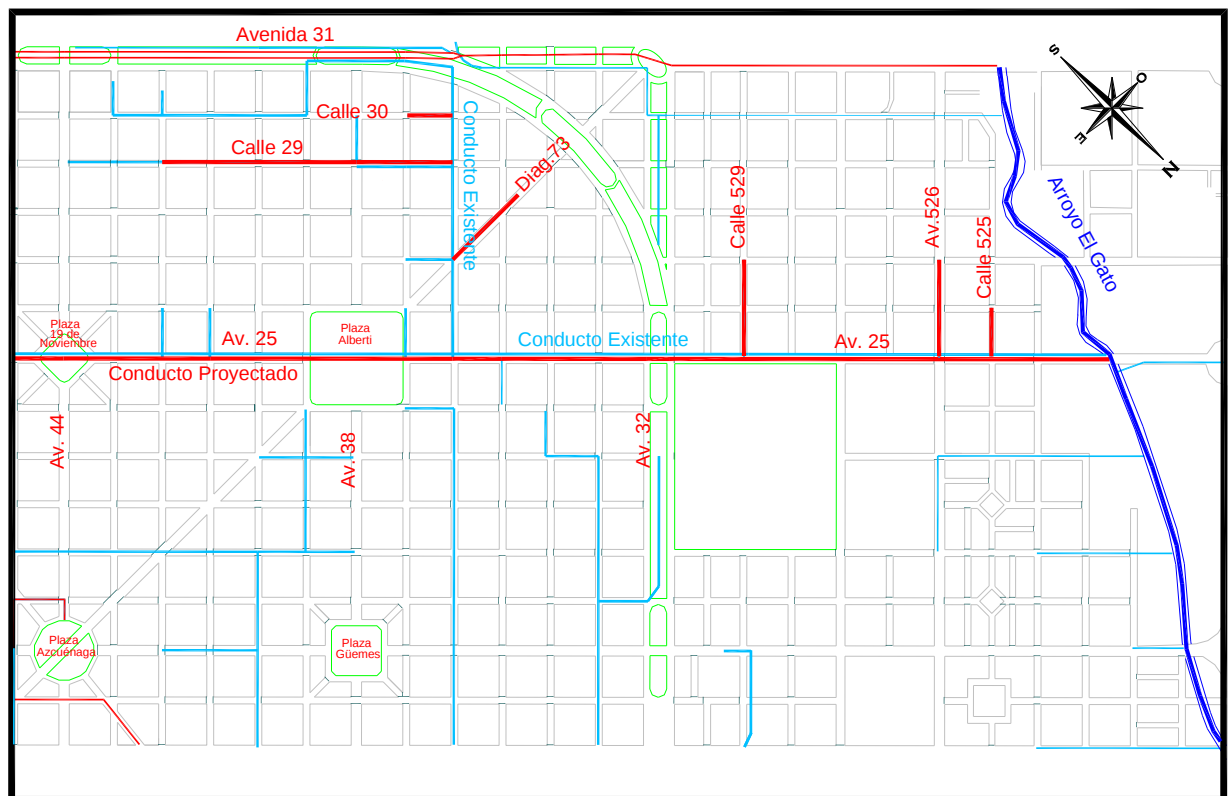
Detalle de la traza del conducto desde la Avenida 44 hasta el Arroyo
